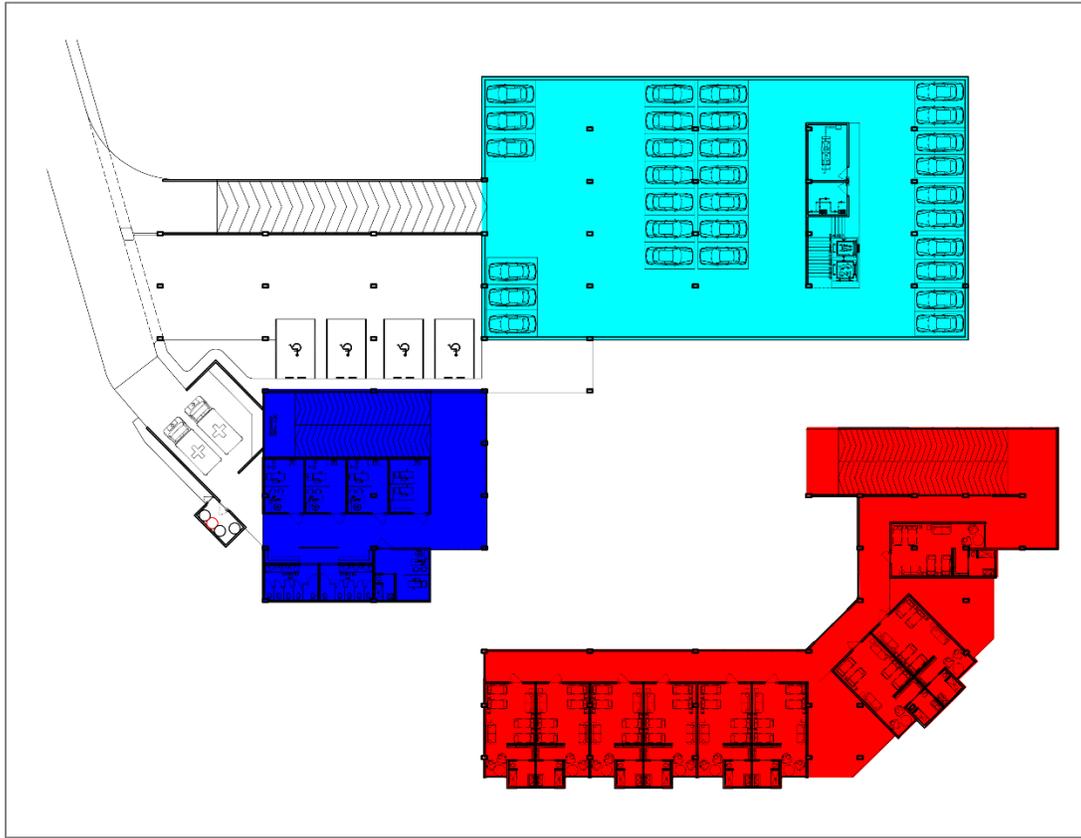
Zonificación Planta 2 (Rubiano, 2020)
